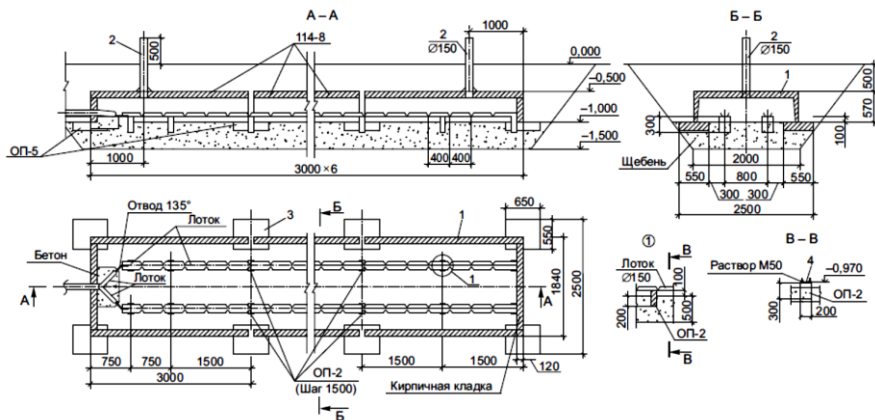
Схема вентилируемых площадок [1]:
